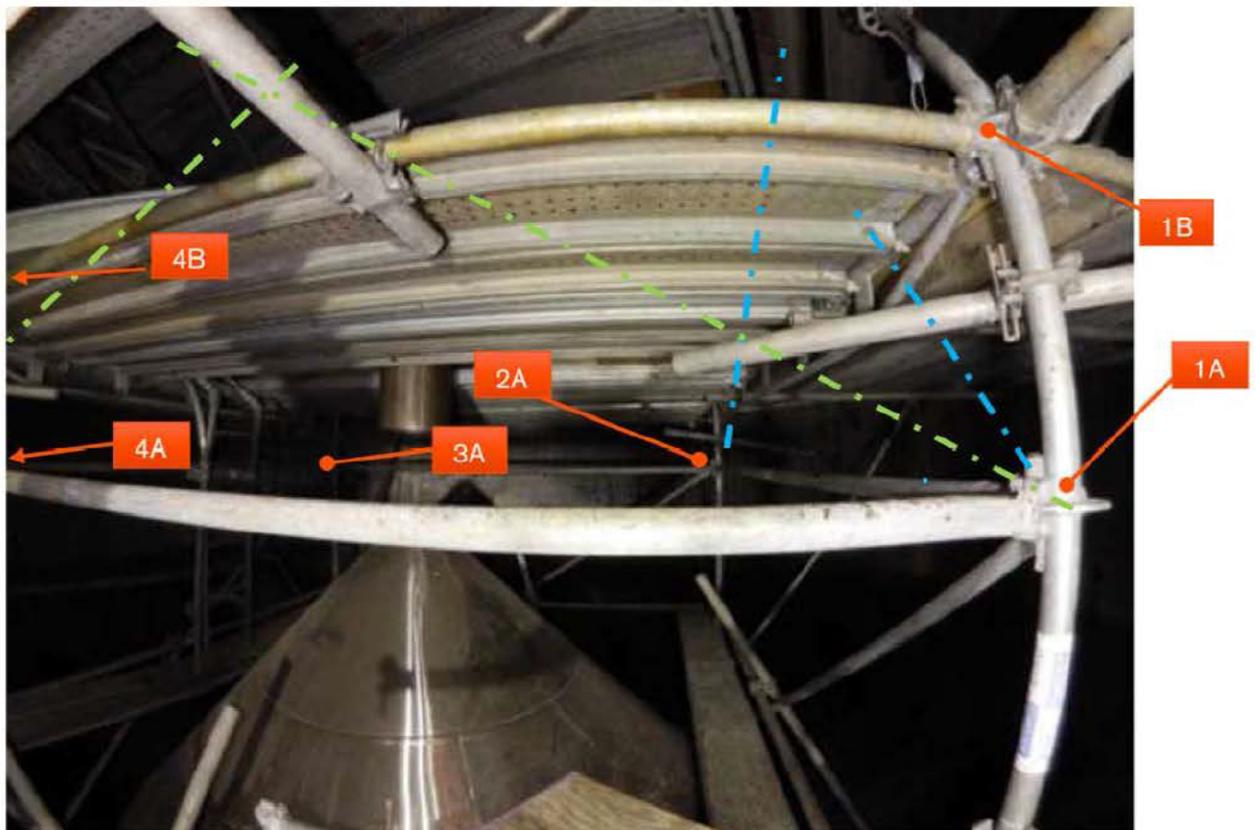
Prise #1 - Manhole - Face (Drone) et extrait des plans correspondants
